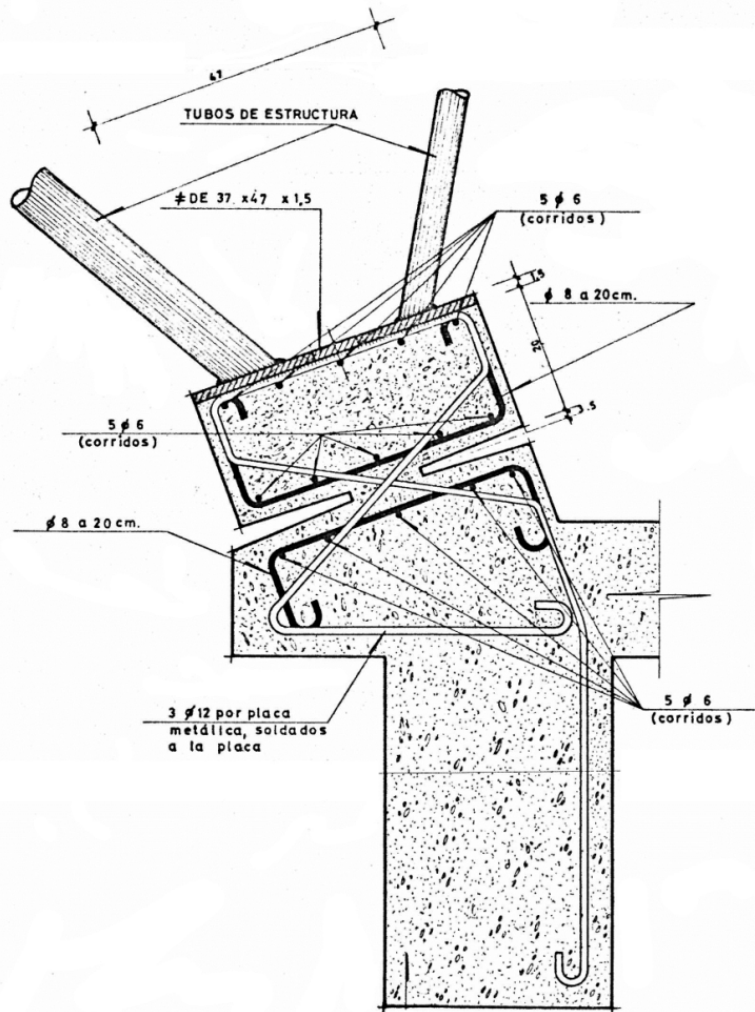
Detalle del armado para la ejecución de la rótula plástica de apoyo.
